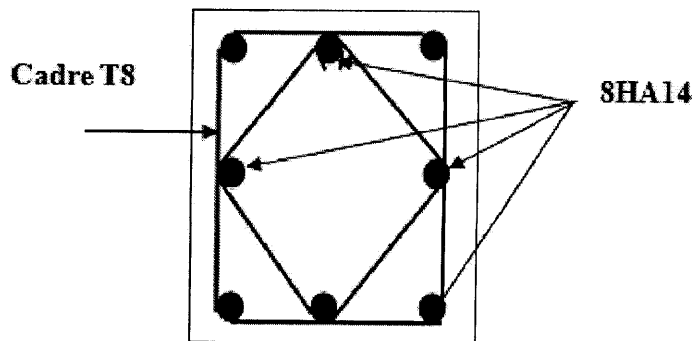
schéma de ferrailage des poteaux 40×35.
